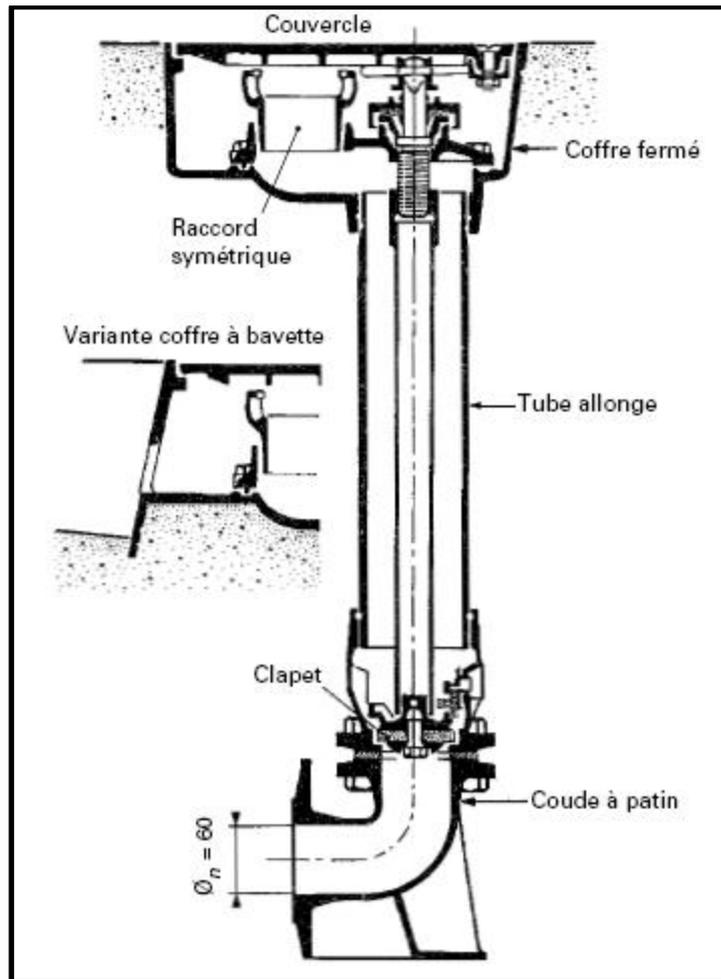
Bouche d'incendie ou de lavage (D'après document Pont-à-Mousson).
